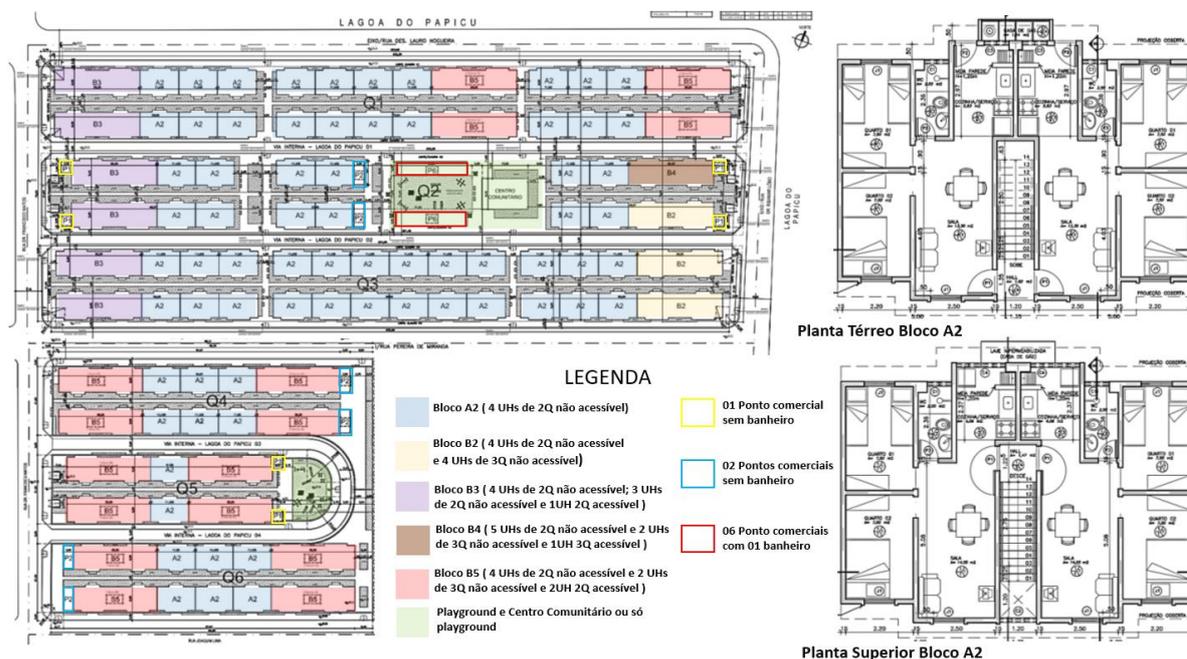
Planta de implantação setorizada e planta baixa Térrea e superior do Bloco A2.
